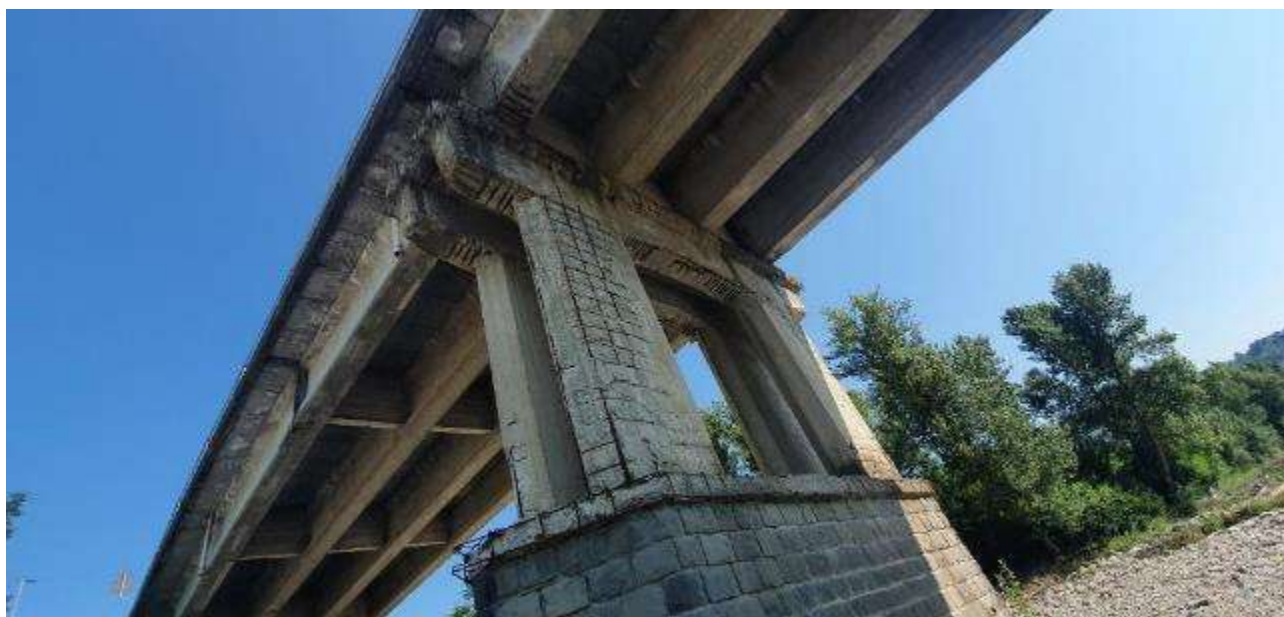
Vista del degrado di basamento-pila e trave pulvino
